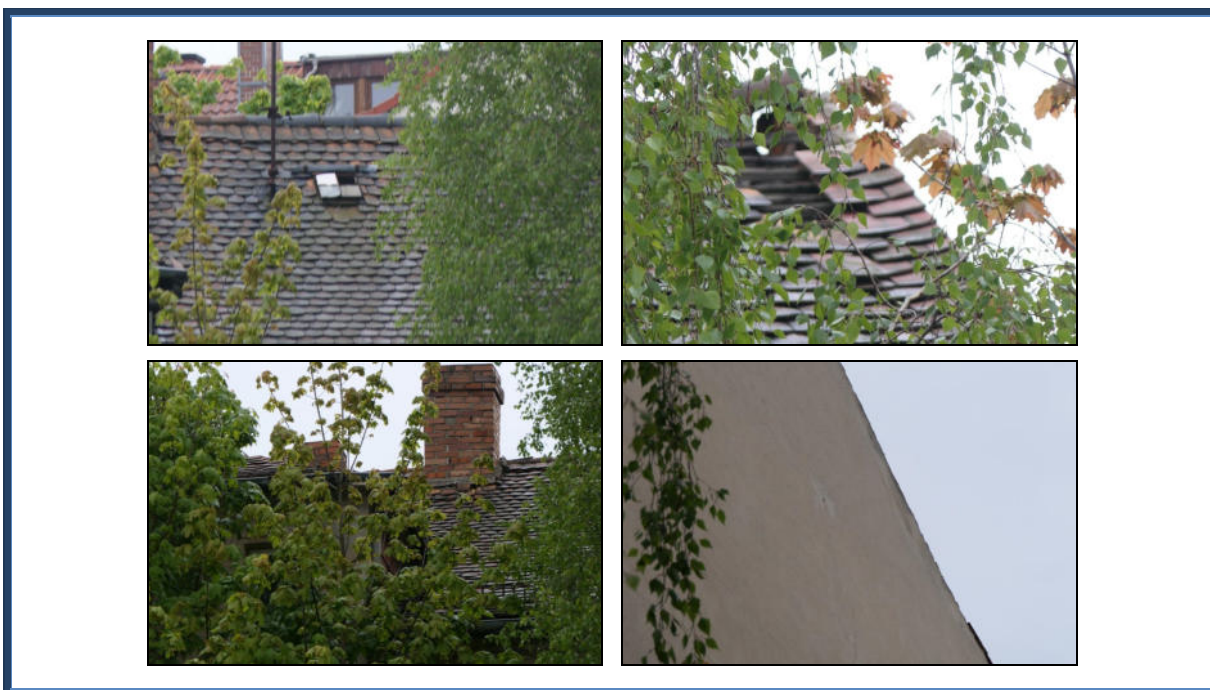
Detailansichten: Schäden an der Dacheindeckung
